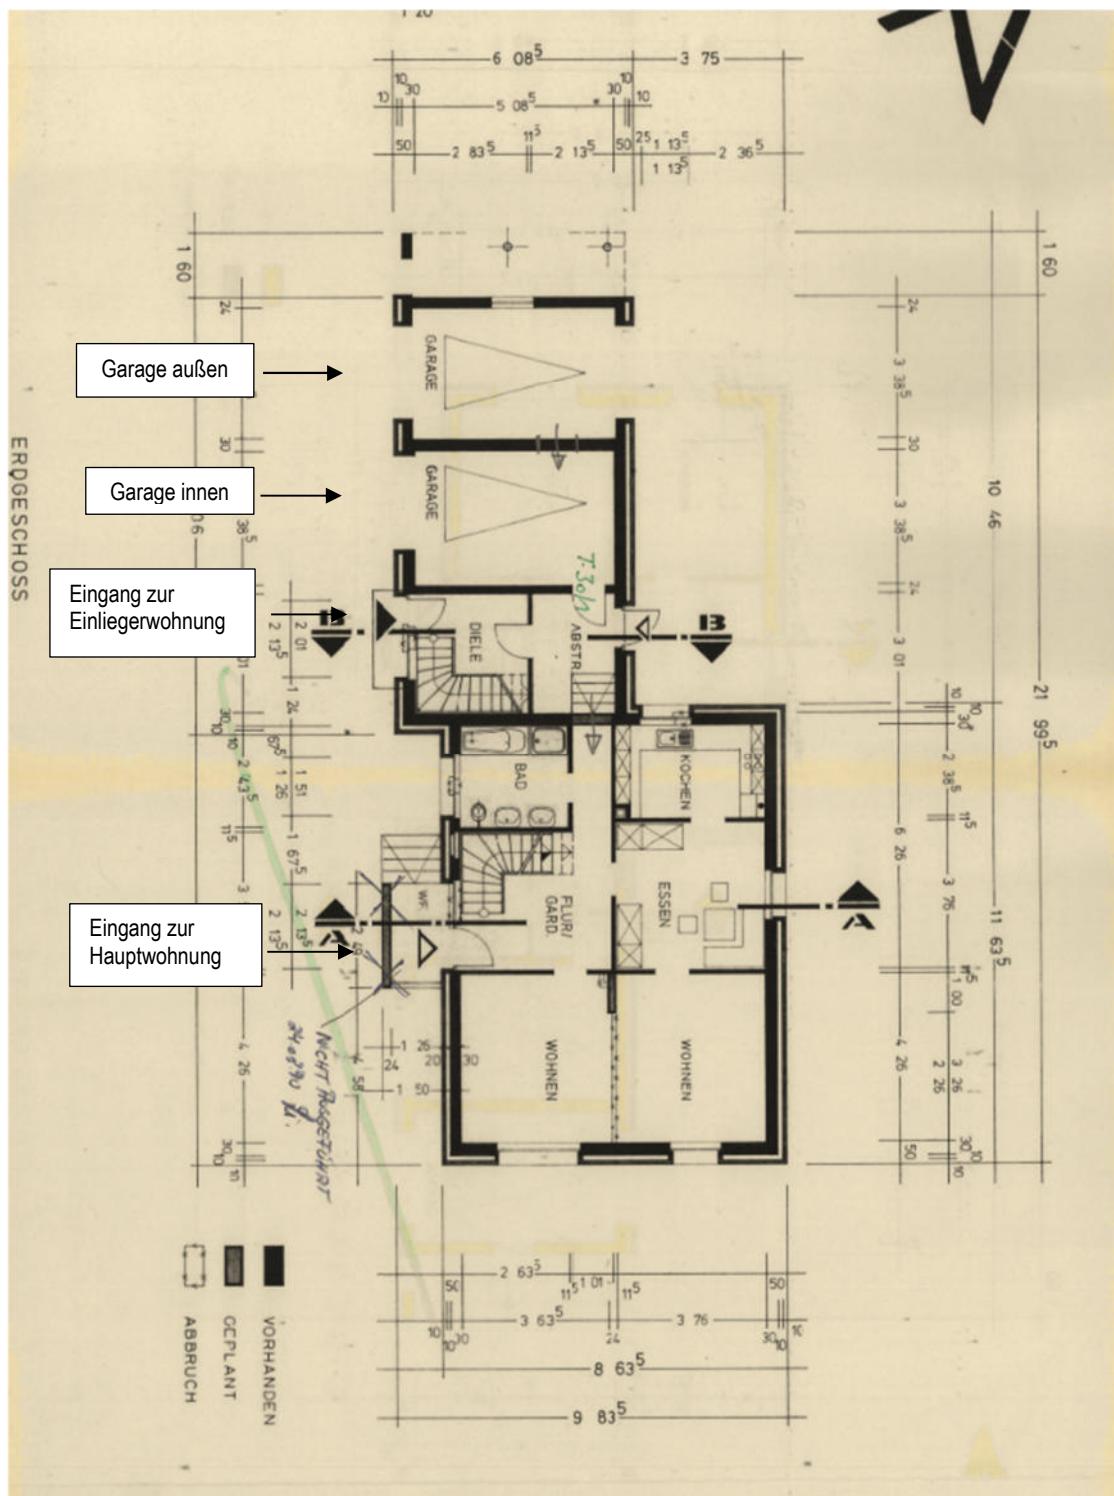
Erdgeschoss / Plan aus der Bauakte Abweichungen vor Ort sind möglich
